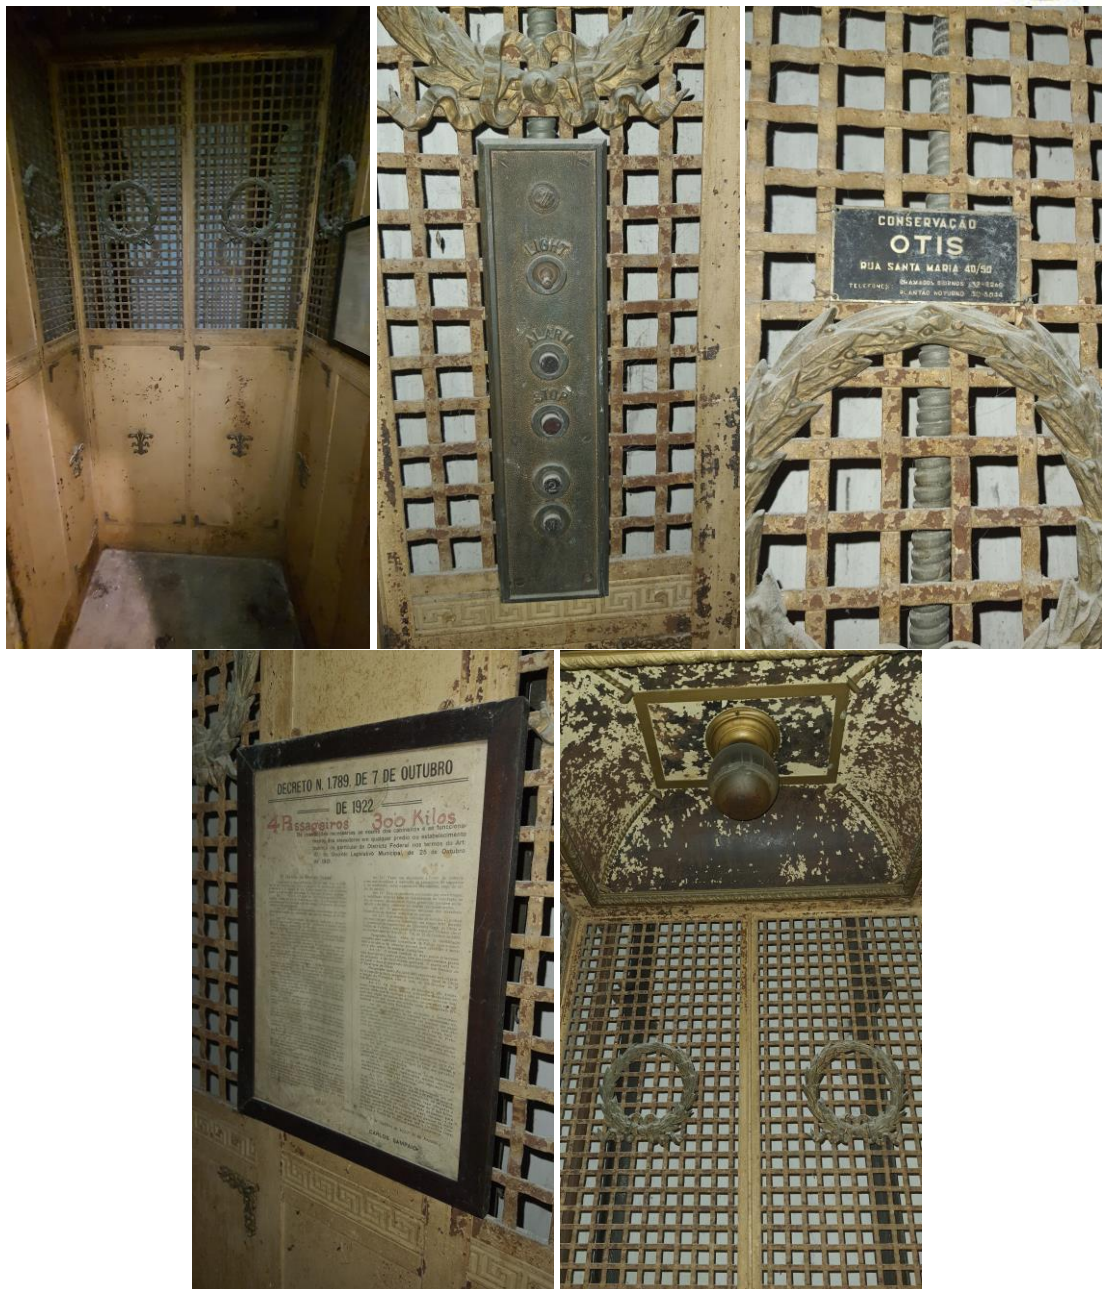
Vistas da cabine do elevador, original à construção da edificação, com detalhes nos metais e informações acerca de sua utilização.
